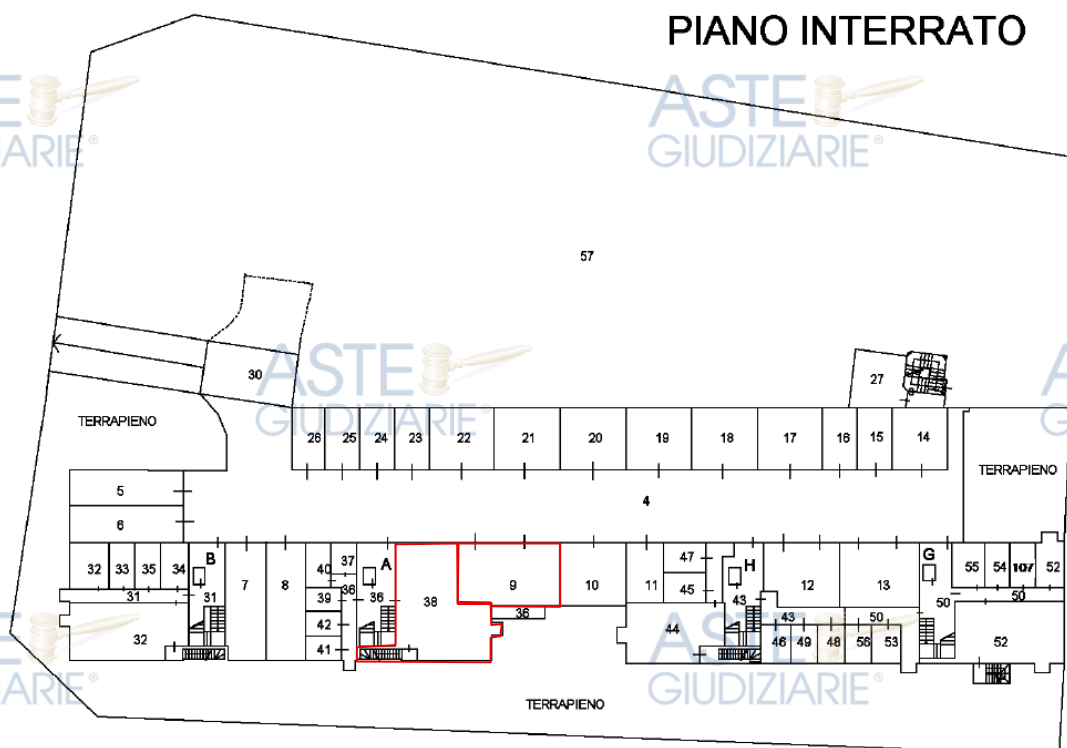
Planimetria dell’elaborato planimetrico – Piano Interrato
